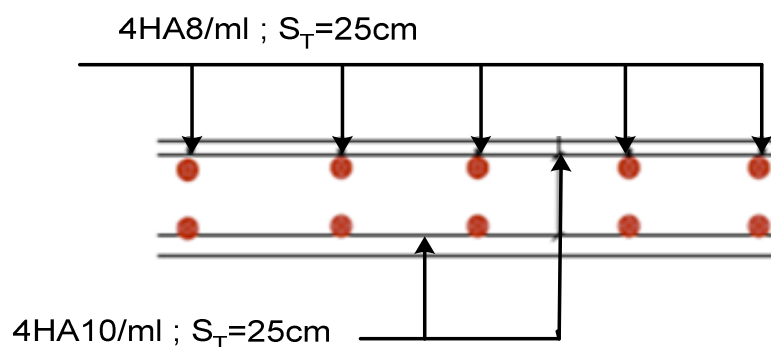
Schéma de ferrailage balcon sur trois appuis (Type1).
